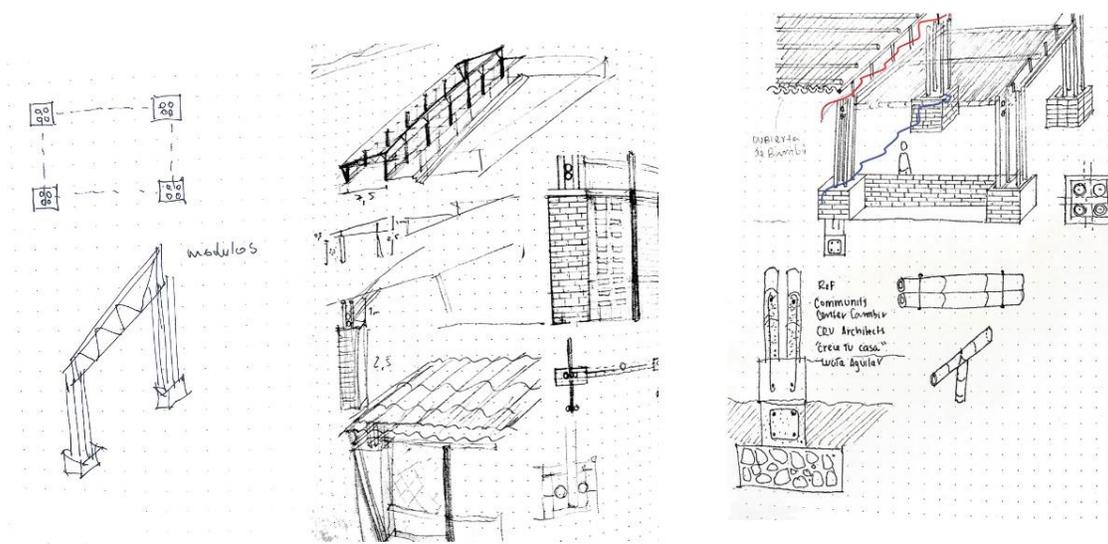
Exploración de módulos estructurales y sistema constructivo de mampostería y bambú;
